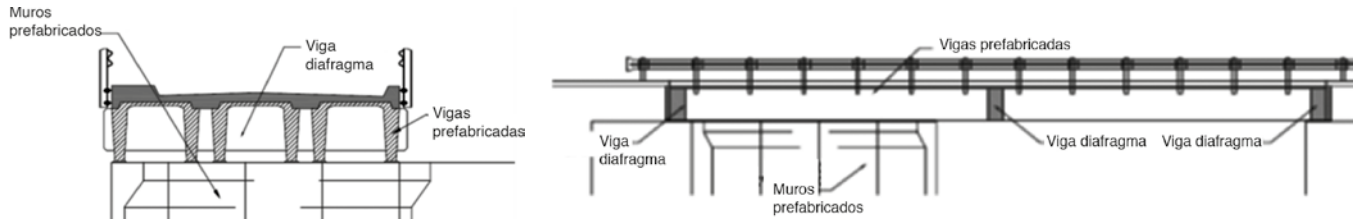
Ejemplo de vigas diafragma prefabricadas de concreto
